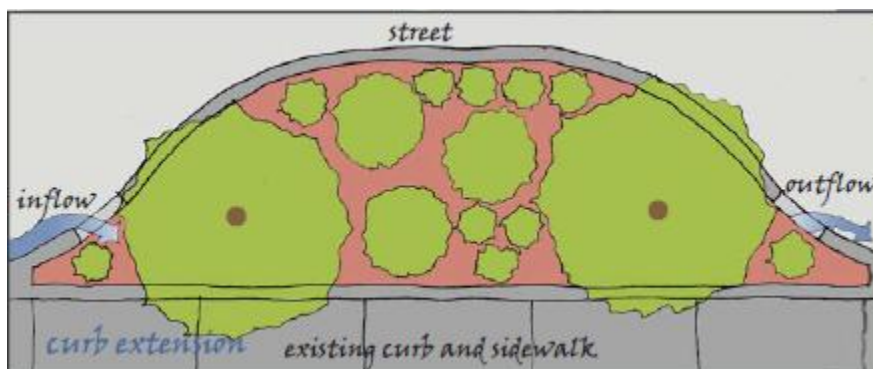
Vista superior de projeto de canteiro pluvial no formato de extensão da calçada
